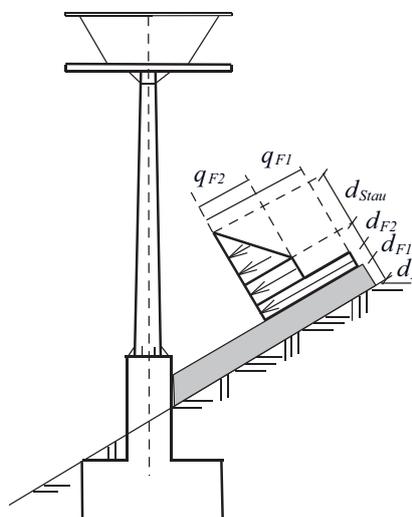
Pylône tubulaire sur fondation béton à fleur de terrain.
